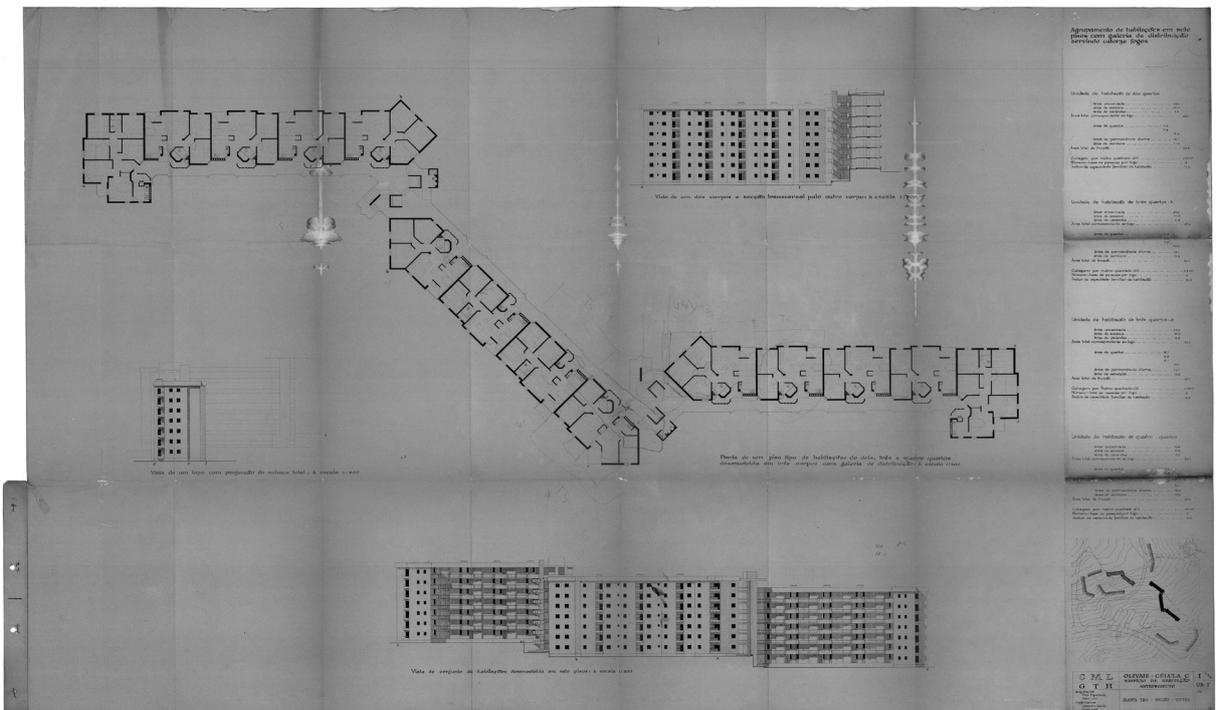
Anteprojeto: planta tipo, secção e vistas
